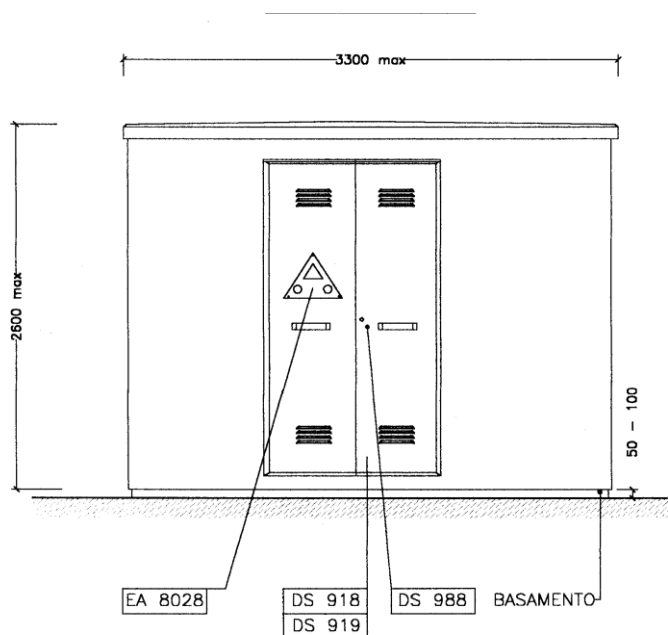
Layout cabina E-Distribuzione – vista frontale
